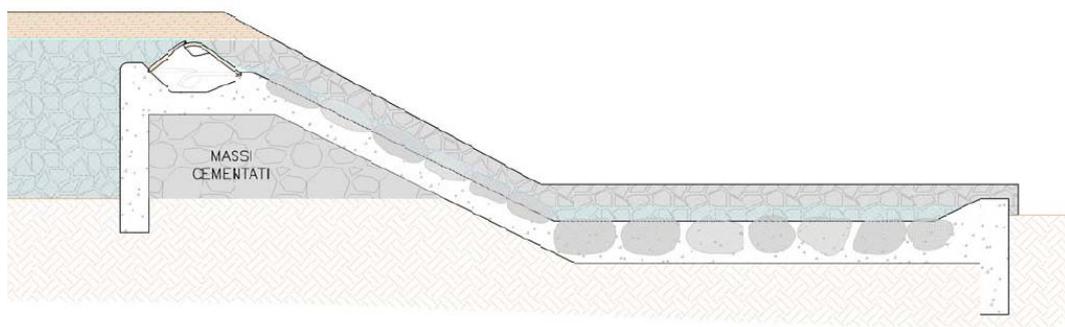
Sezione trasversale della traversa di derivazione in progetto
